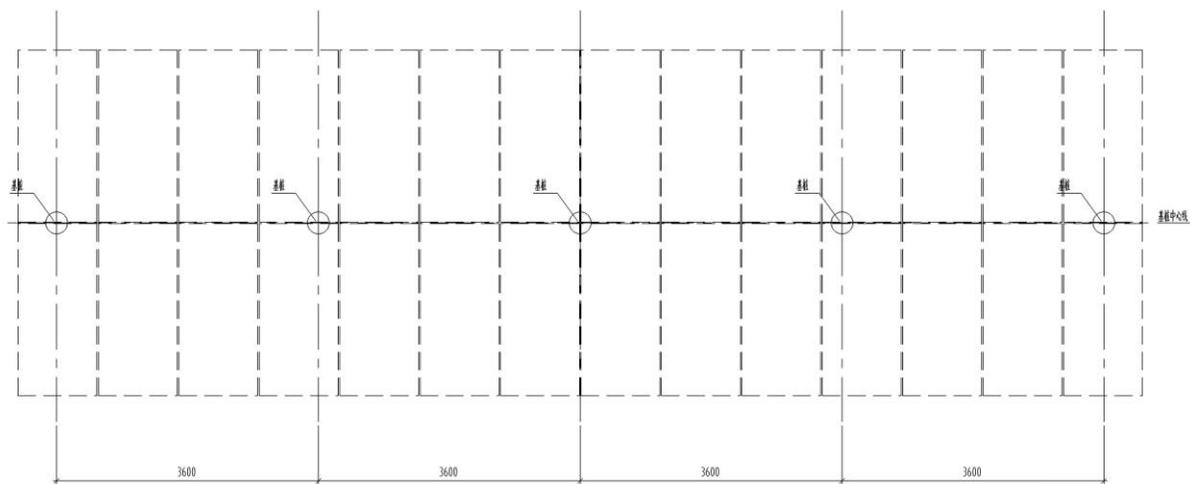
2×14 阵列光伏支架桩基础平面布置示意图
